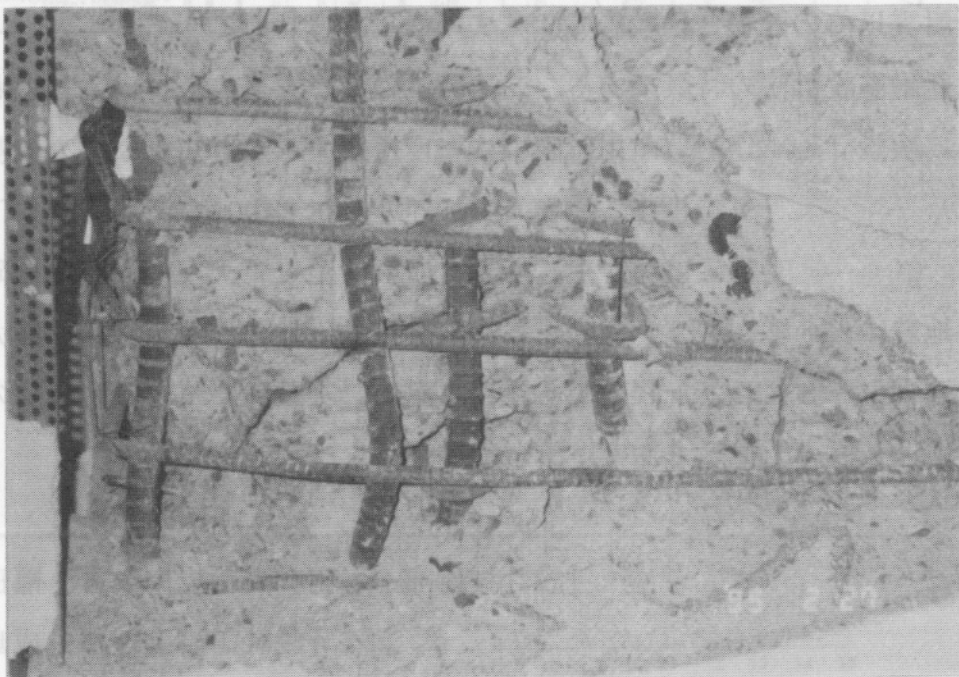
RC造柱曲げ降伏例（詳細）
